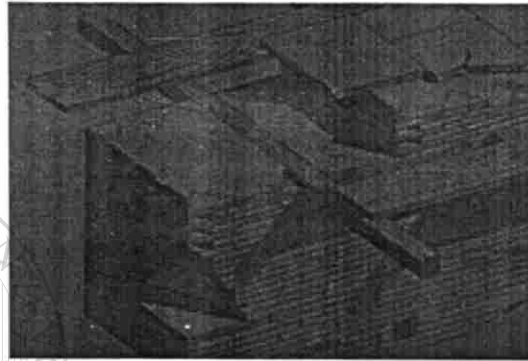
Construcción tradicional de un muro de mampostería reforzada, en la antigua Roma.
